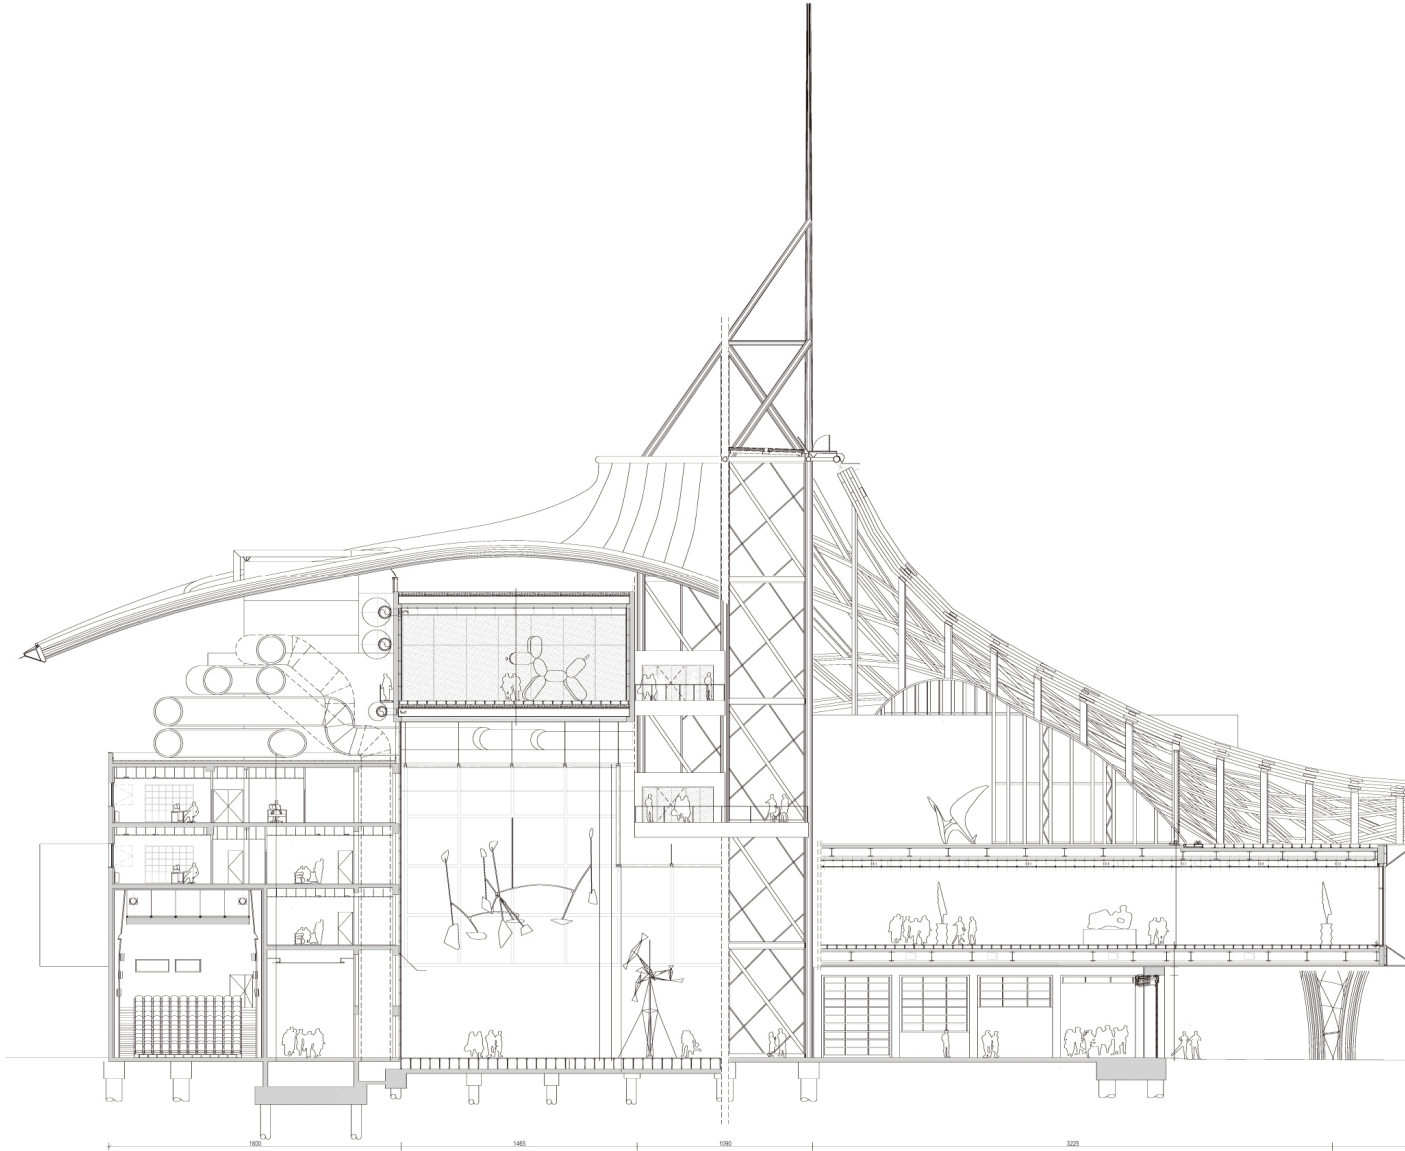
Centro Pompidou-Metz en Francia por shigeru Ban Corte arquitectónico.Fuente:
